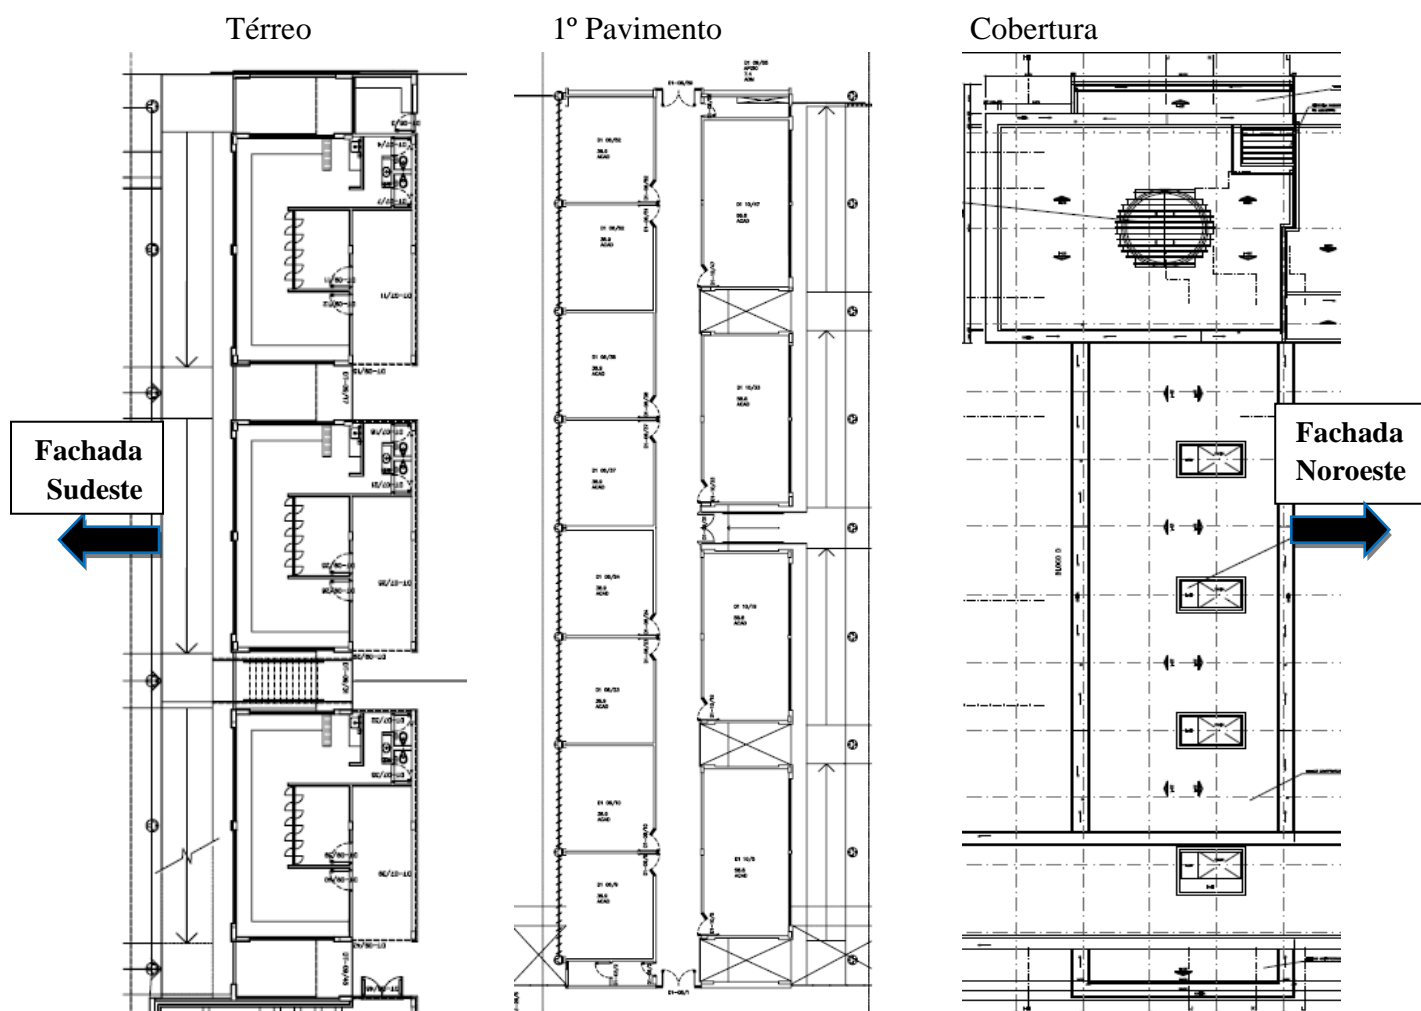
Plantas do térreo, 1º pavimento e cobertura, respectivamente, do bloco D da FACE. Plantas também se encontram no Anexo, em escala 1/250 (fonte: CEPLAN, UnB, 2014)
